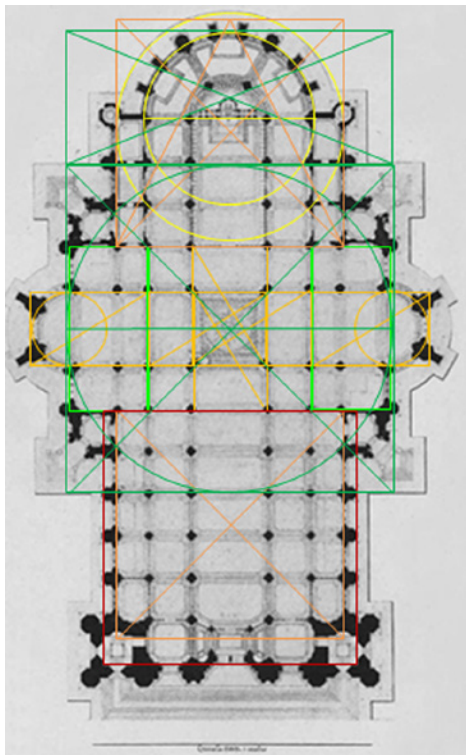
y 7. Análisis geométrico de la planta y la fachada.
